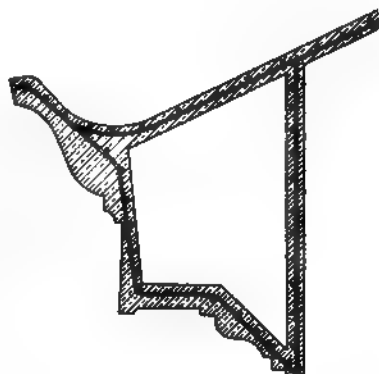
Dachrinne beim Wasserwerk Truppentübingplatz Senne.
